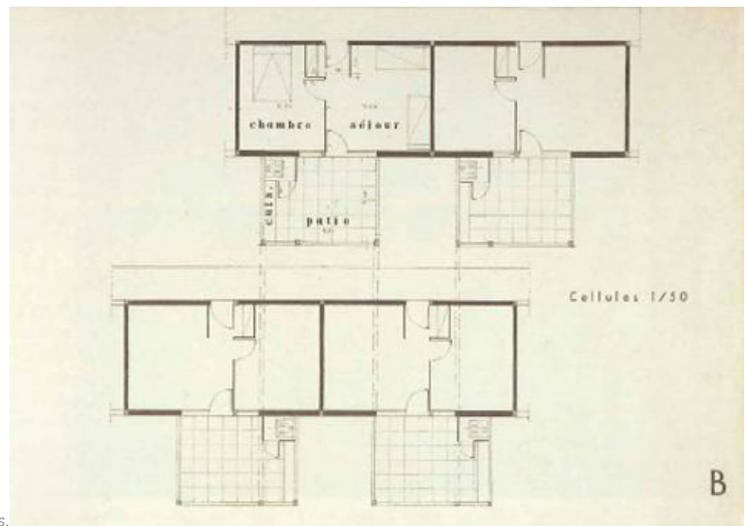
Planta en detalle, modelo Musulmán. Nid d'abeilles.
